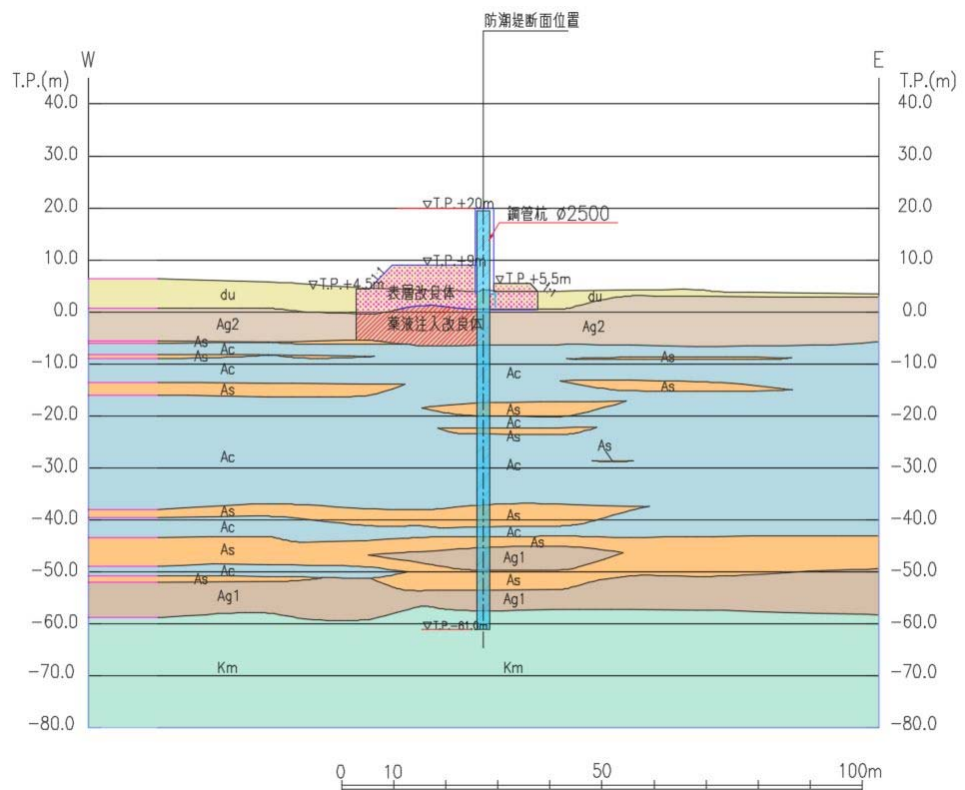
(2) 耐震評価対象断面 (鋼管杭鉄筋コンクリート防潮壁 断面③)
